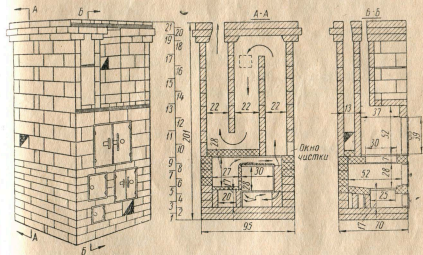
Шведка уменьшенная трехоборотная конструкции К. Я. Буслаева.
